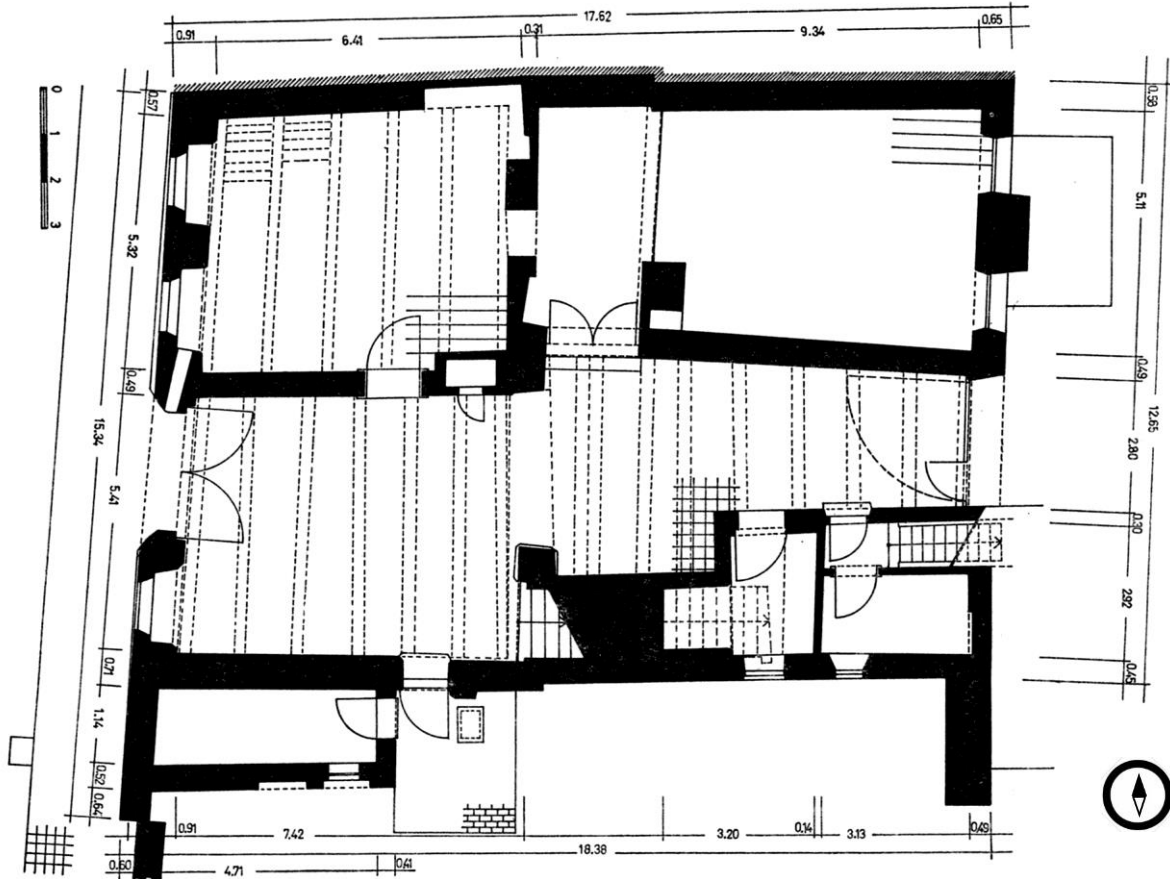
Kastenhaus Dingolfing, Grundriss Erdgeschoss, im Westen Zugang von der Straße
